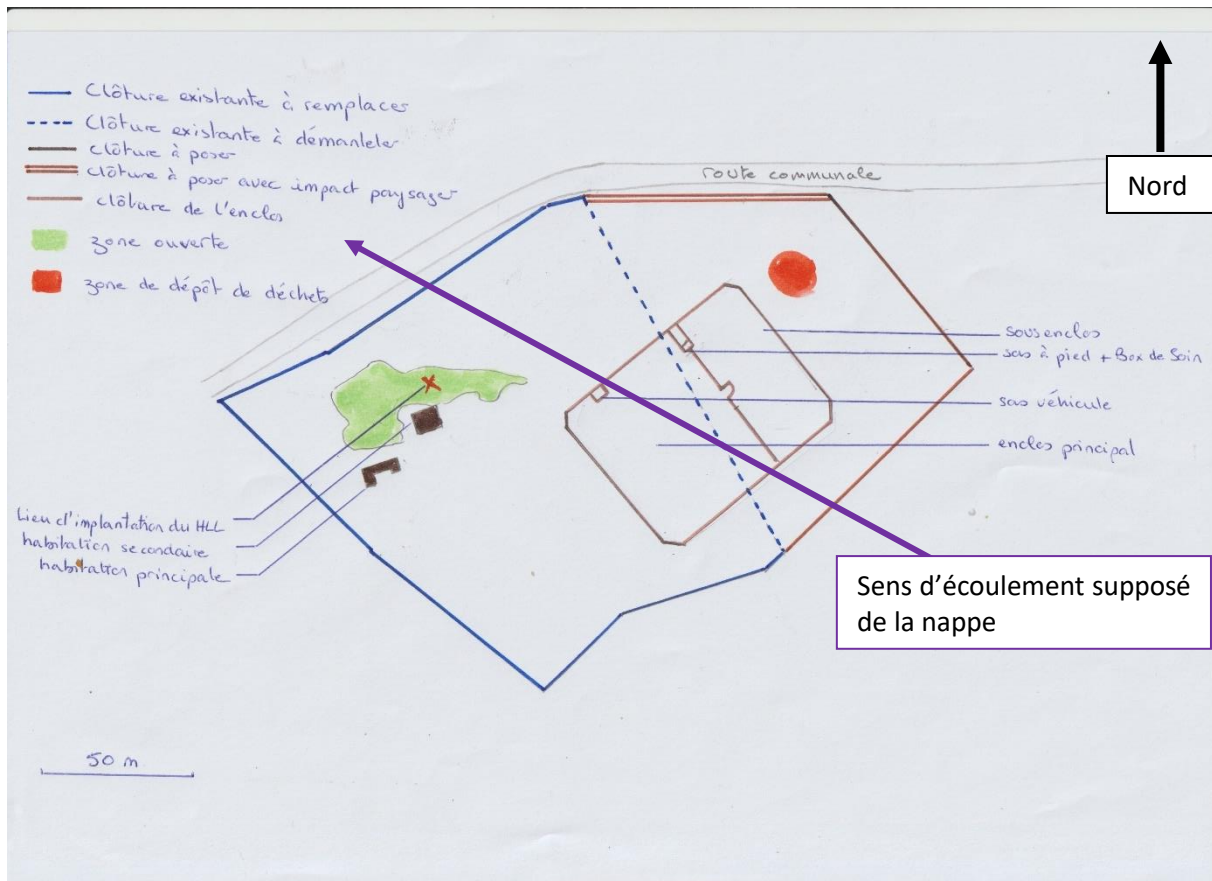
Plan prévisionnel d'implantation de l'enclos des loups (source : Mme Frézar)
